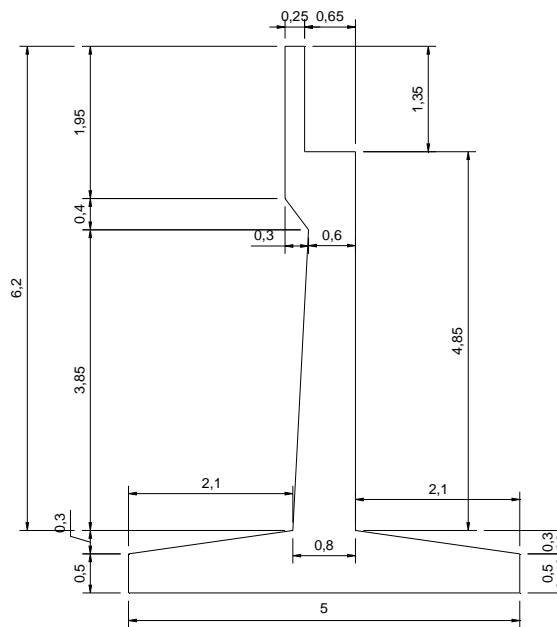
Dimensiones de Estribos.
